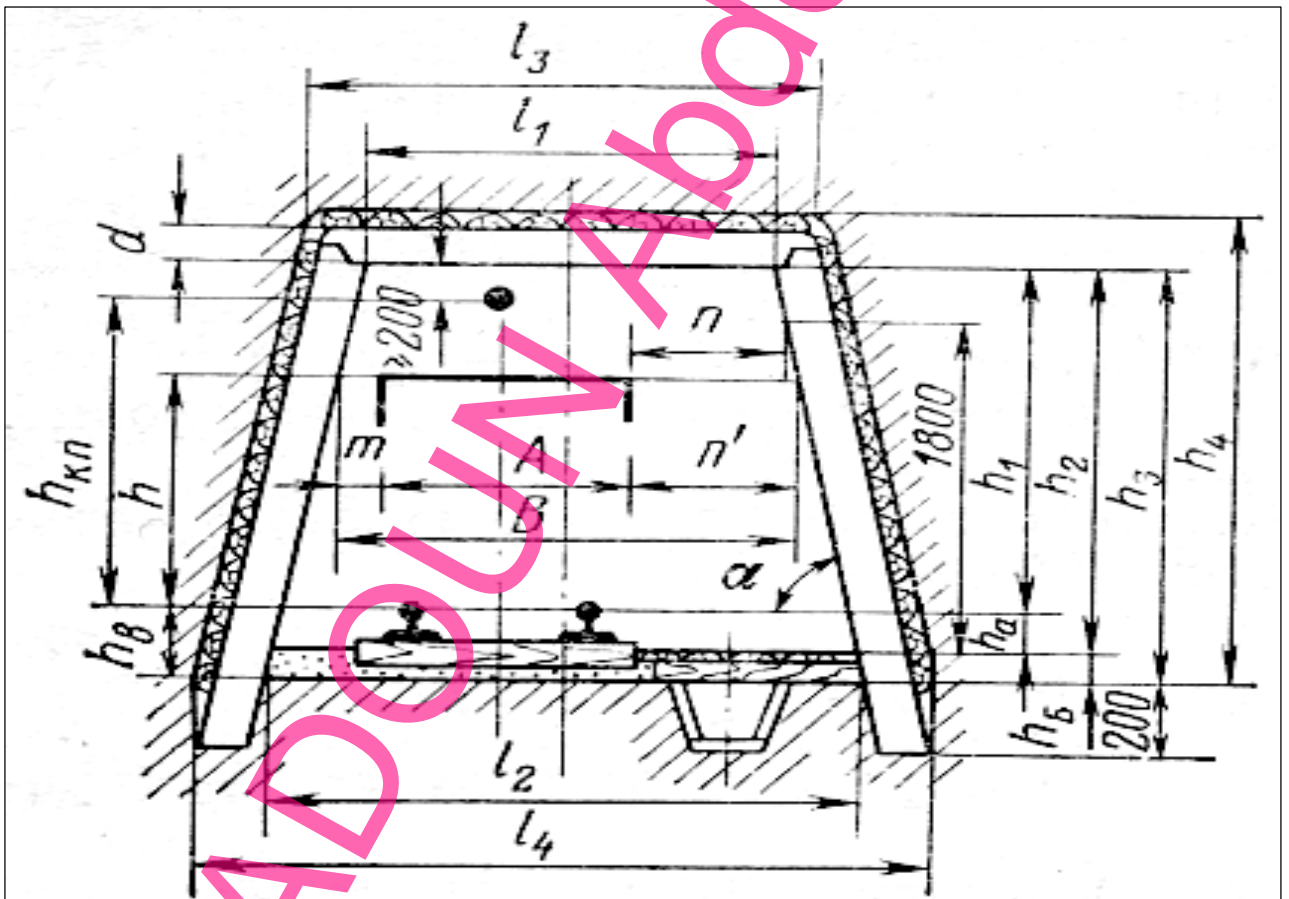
schéma de la section transversale d'une excavation de forme trapézoïdal [23].
